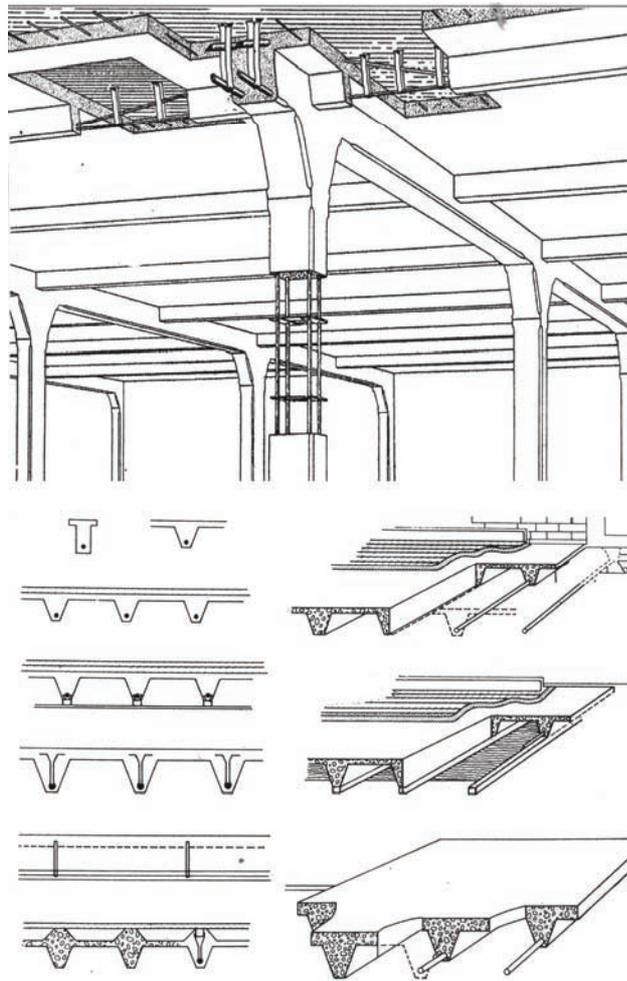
Sistema construtivo em concreto armado de Hennebique, patenteado em 1897.
